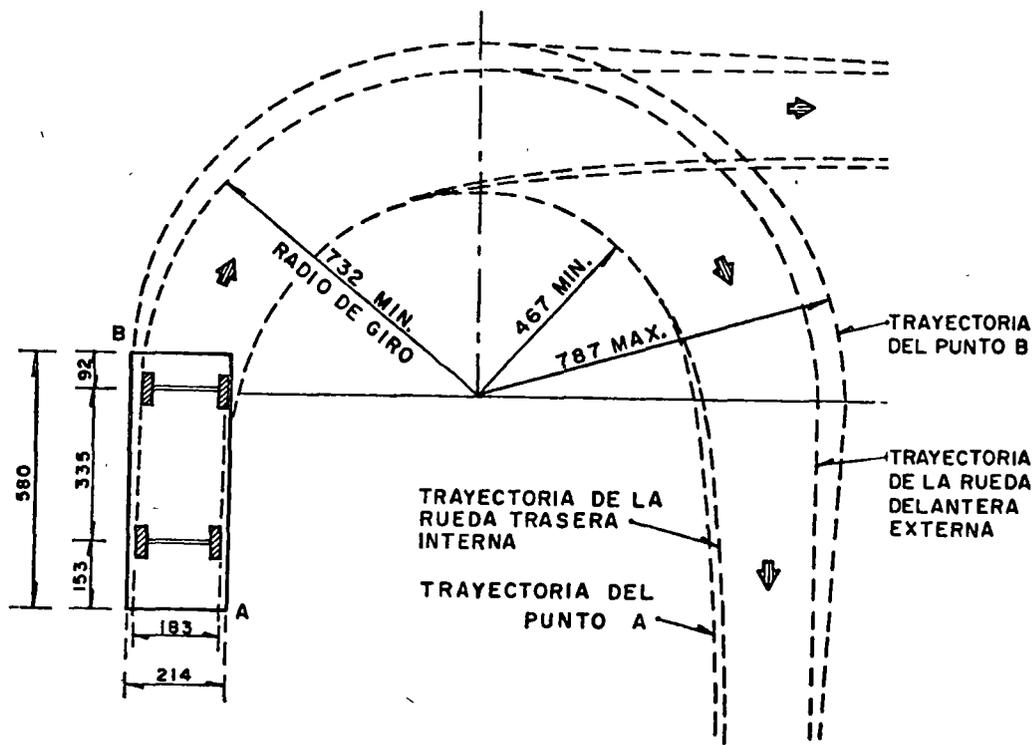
CARACTERISTICAS DEL VEHICULO DE PROYECTO DE-335
